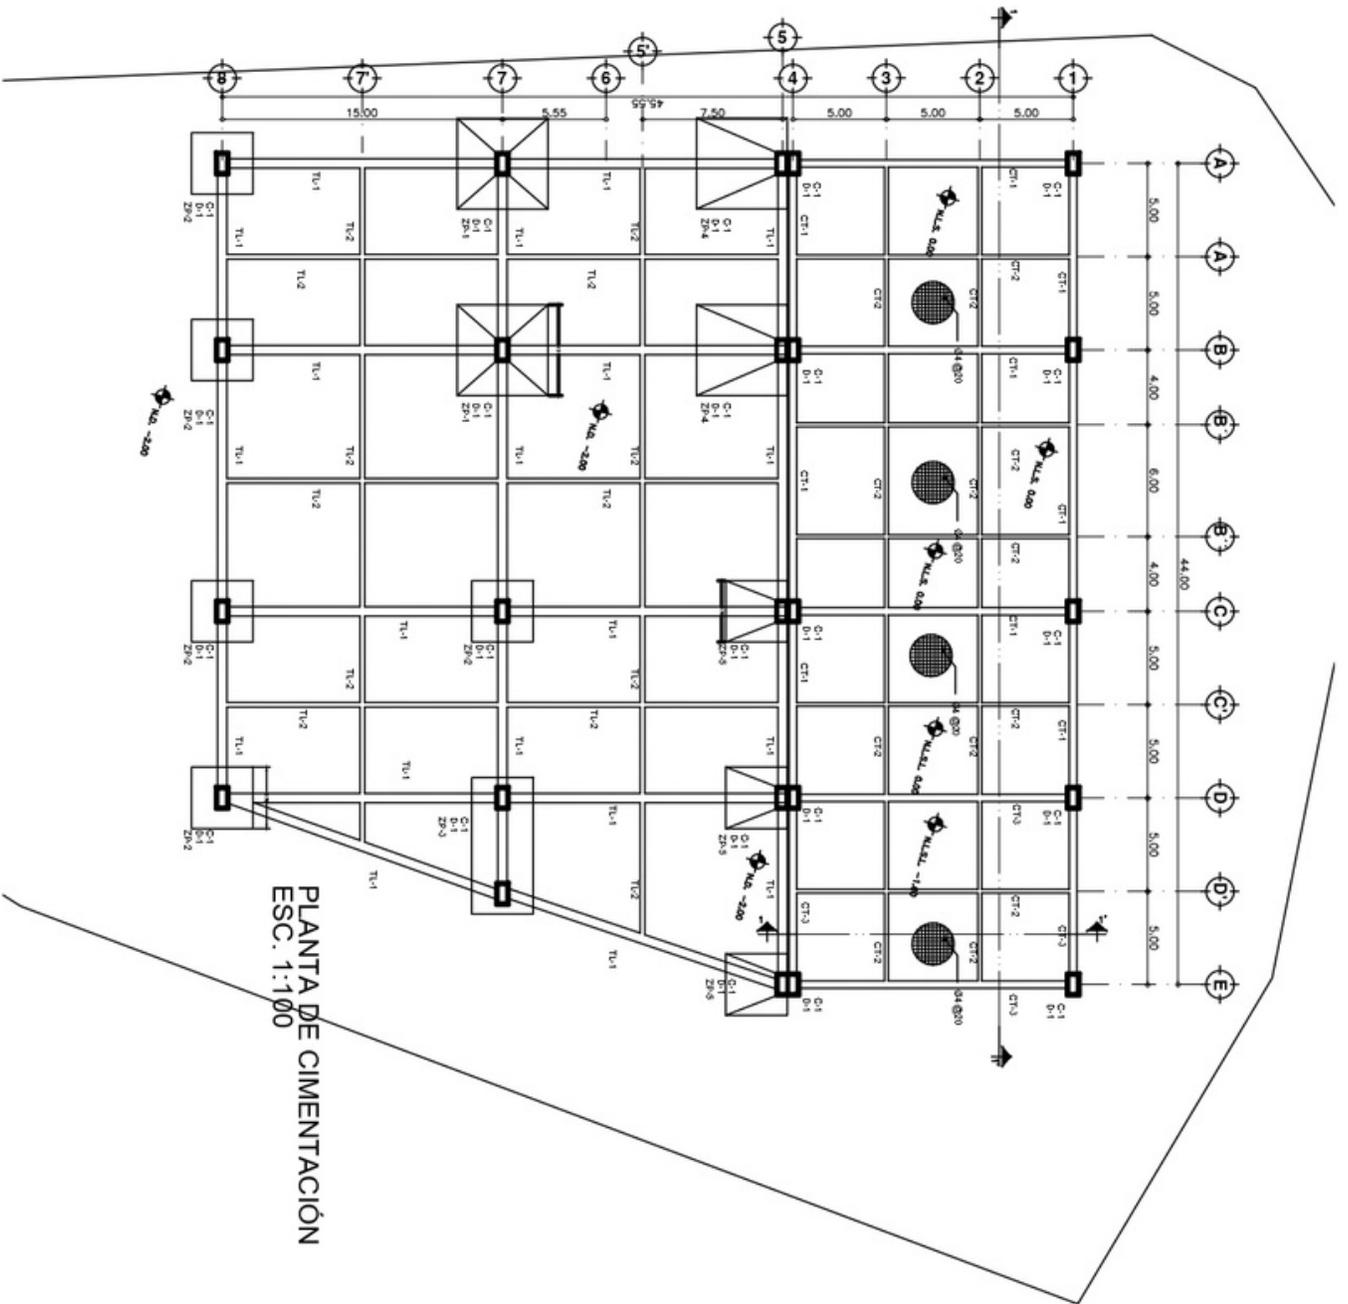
Dimensionamiento de losa de cimentación y contratraves Fuente: Autoría propia
